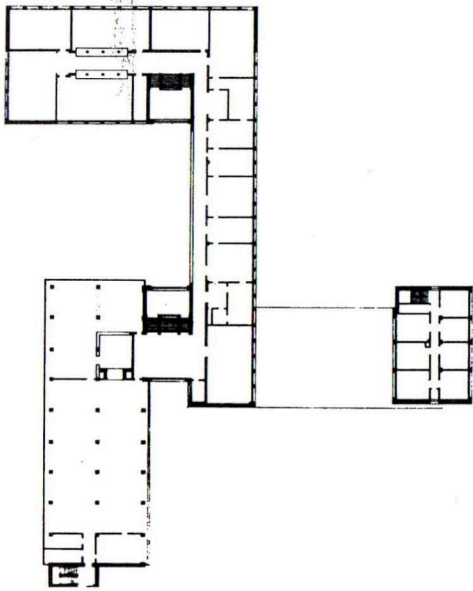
Plano del primer piso de la Bauhaus, Dessau (Walter Gropius, 1925-1926).
